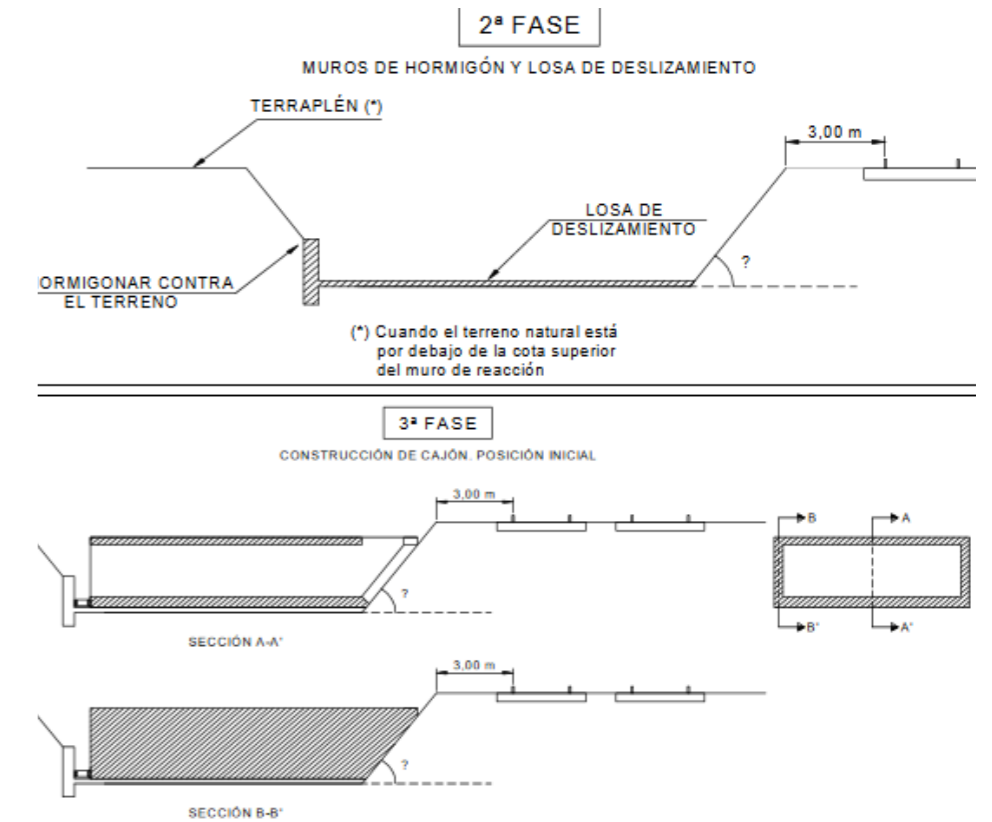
Construcción marco por procedimiento cajón empujado (LiCon Ingeniería)
